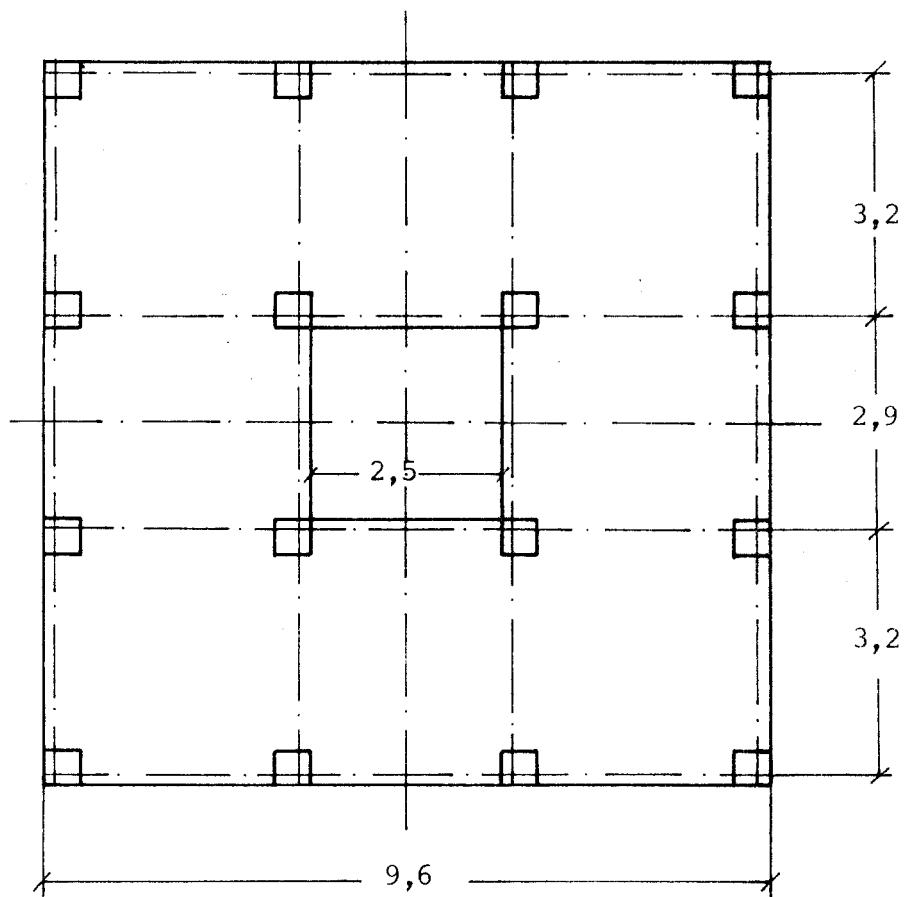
Dimensões em planta do modelo em cm
